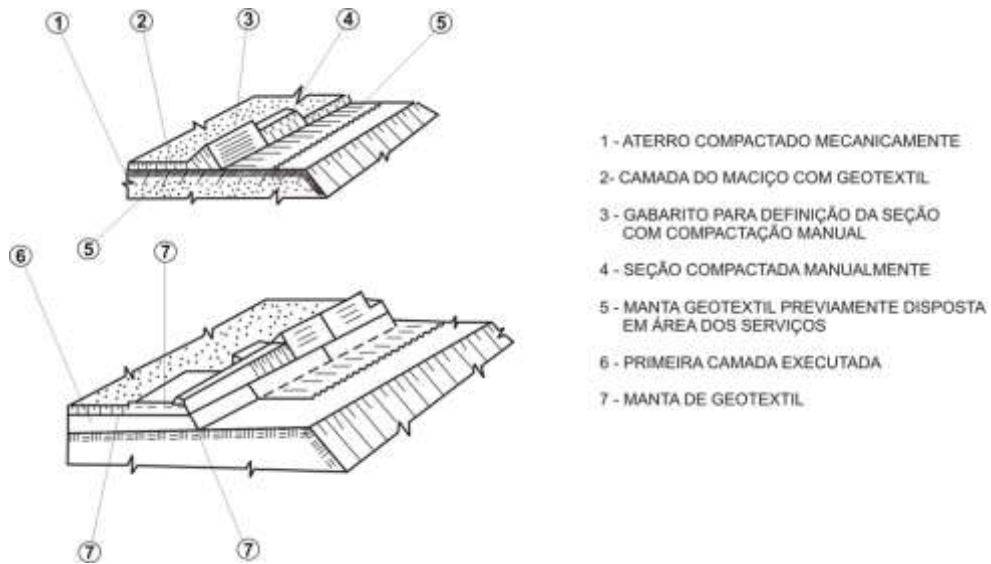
Projeto tipo 6 – Aterro reforçado com geotêxtil.
